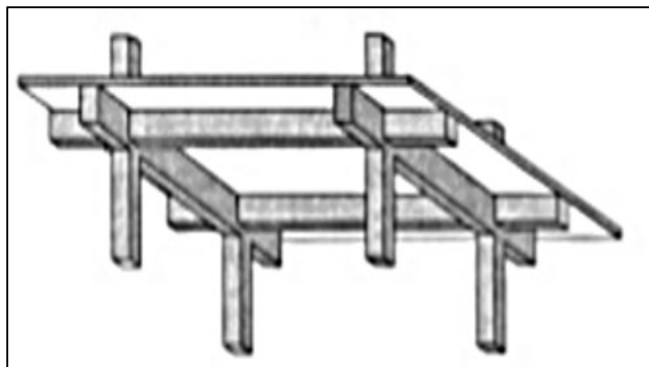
Losa en dos direcciones apoyada en una viga.
